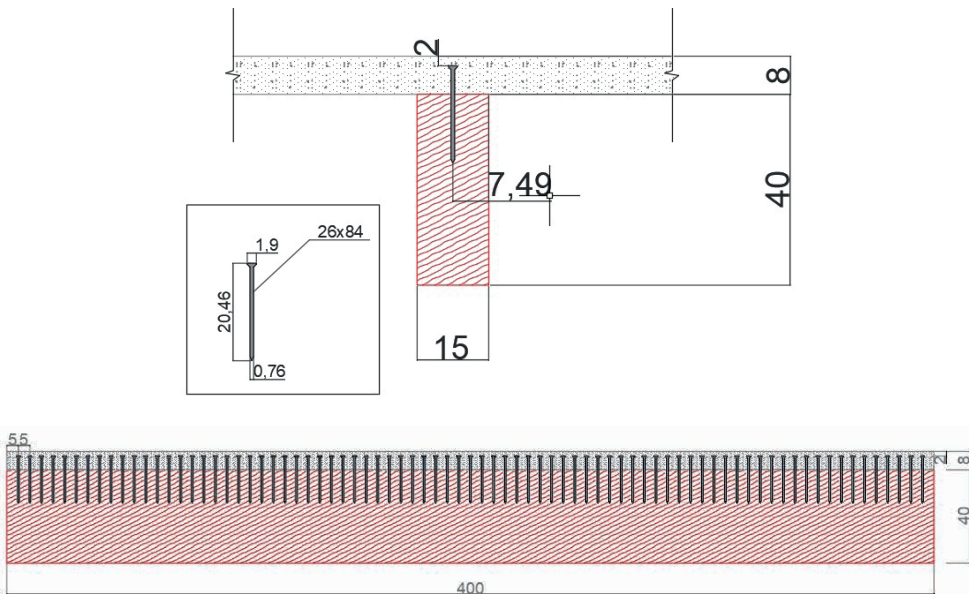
Detalhe da seção transversal e longitudinal da viga mista (cotas em cm)
